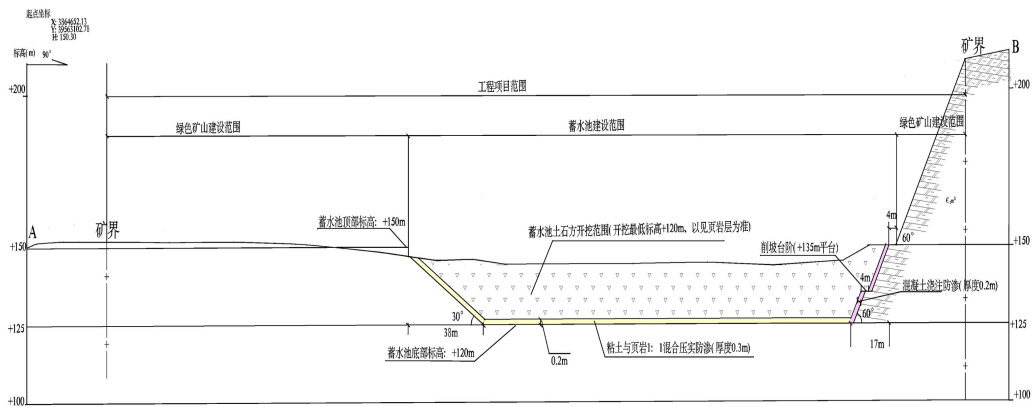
蓄水池 A-B 剖面（横向）施工示意图
